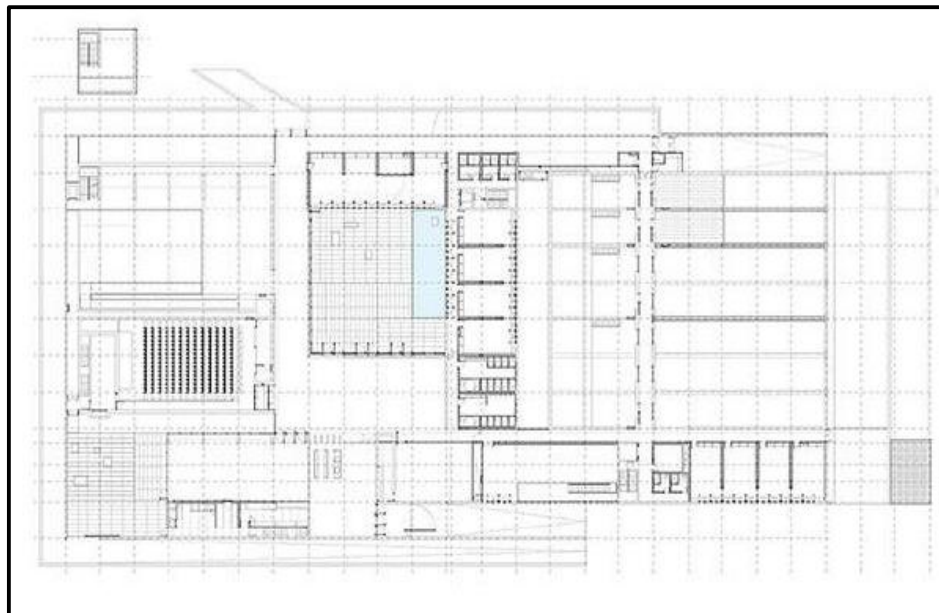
Plan du rez-de-chaussée du musée Madinat Al-Zahra
